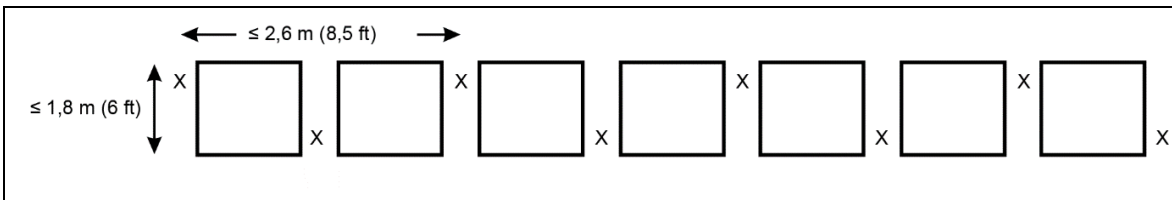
Vista en planta de una configuración alternativa de rociadores intermedios para estanterías simples con una anchura máxima de 1,8 m (6 ft)
